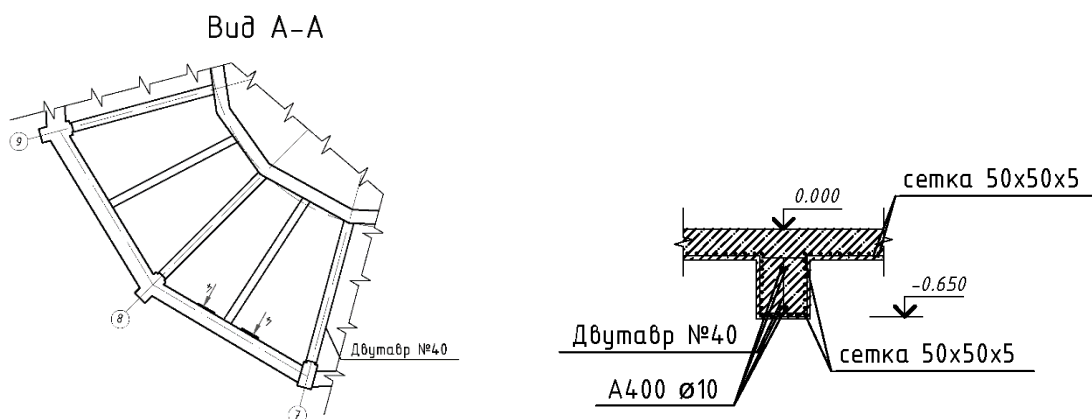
Вид А-А (снизу-вверх), разрез по балке.
